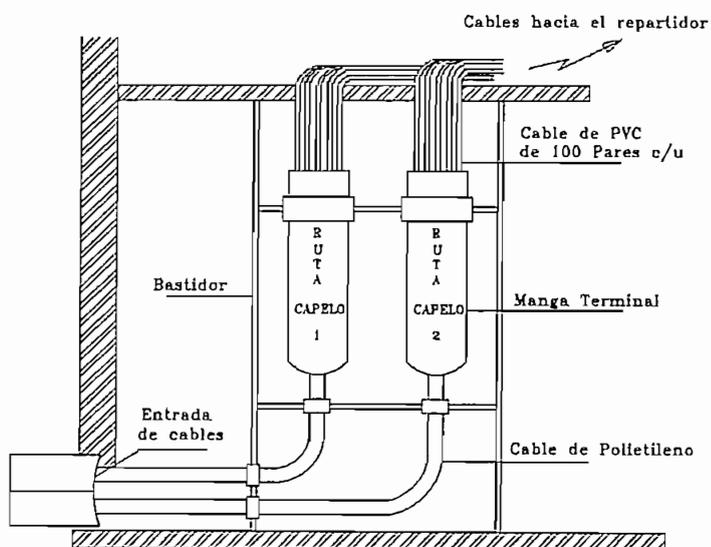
Disposición de Cables y empalmes terminales en la Galería
